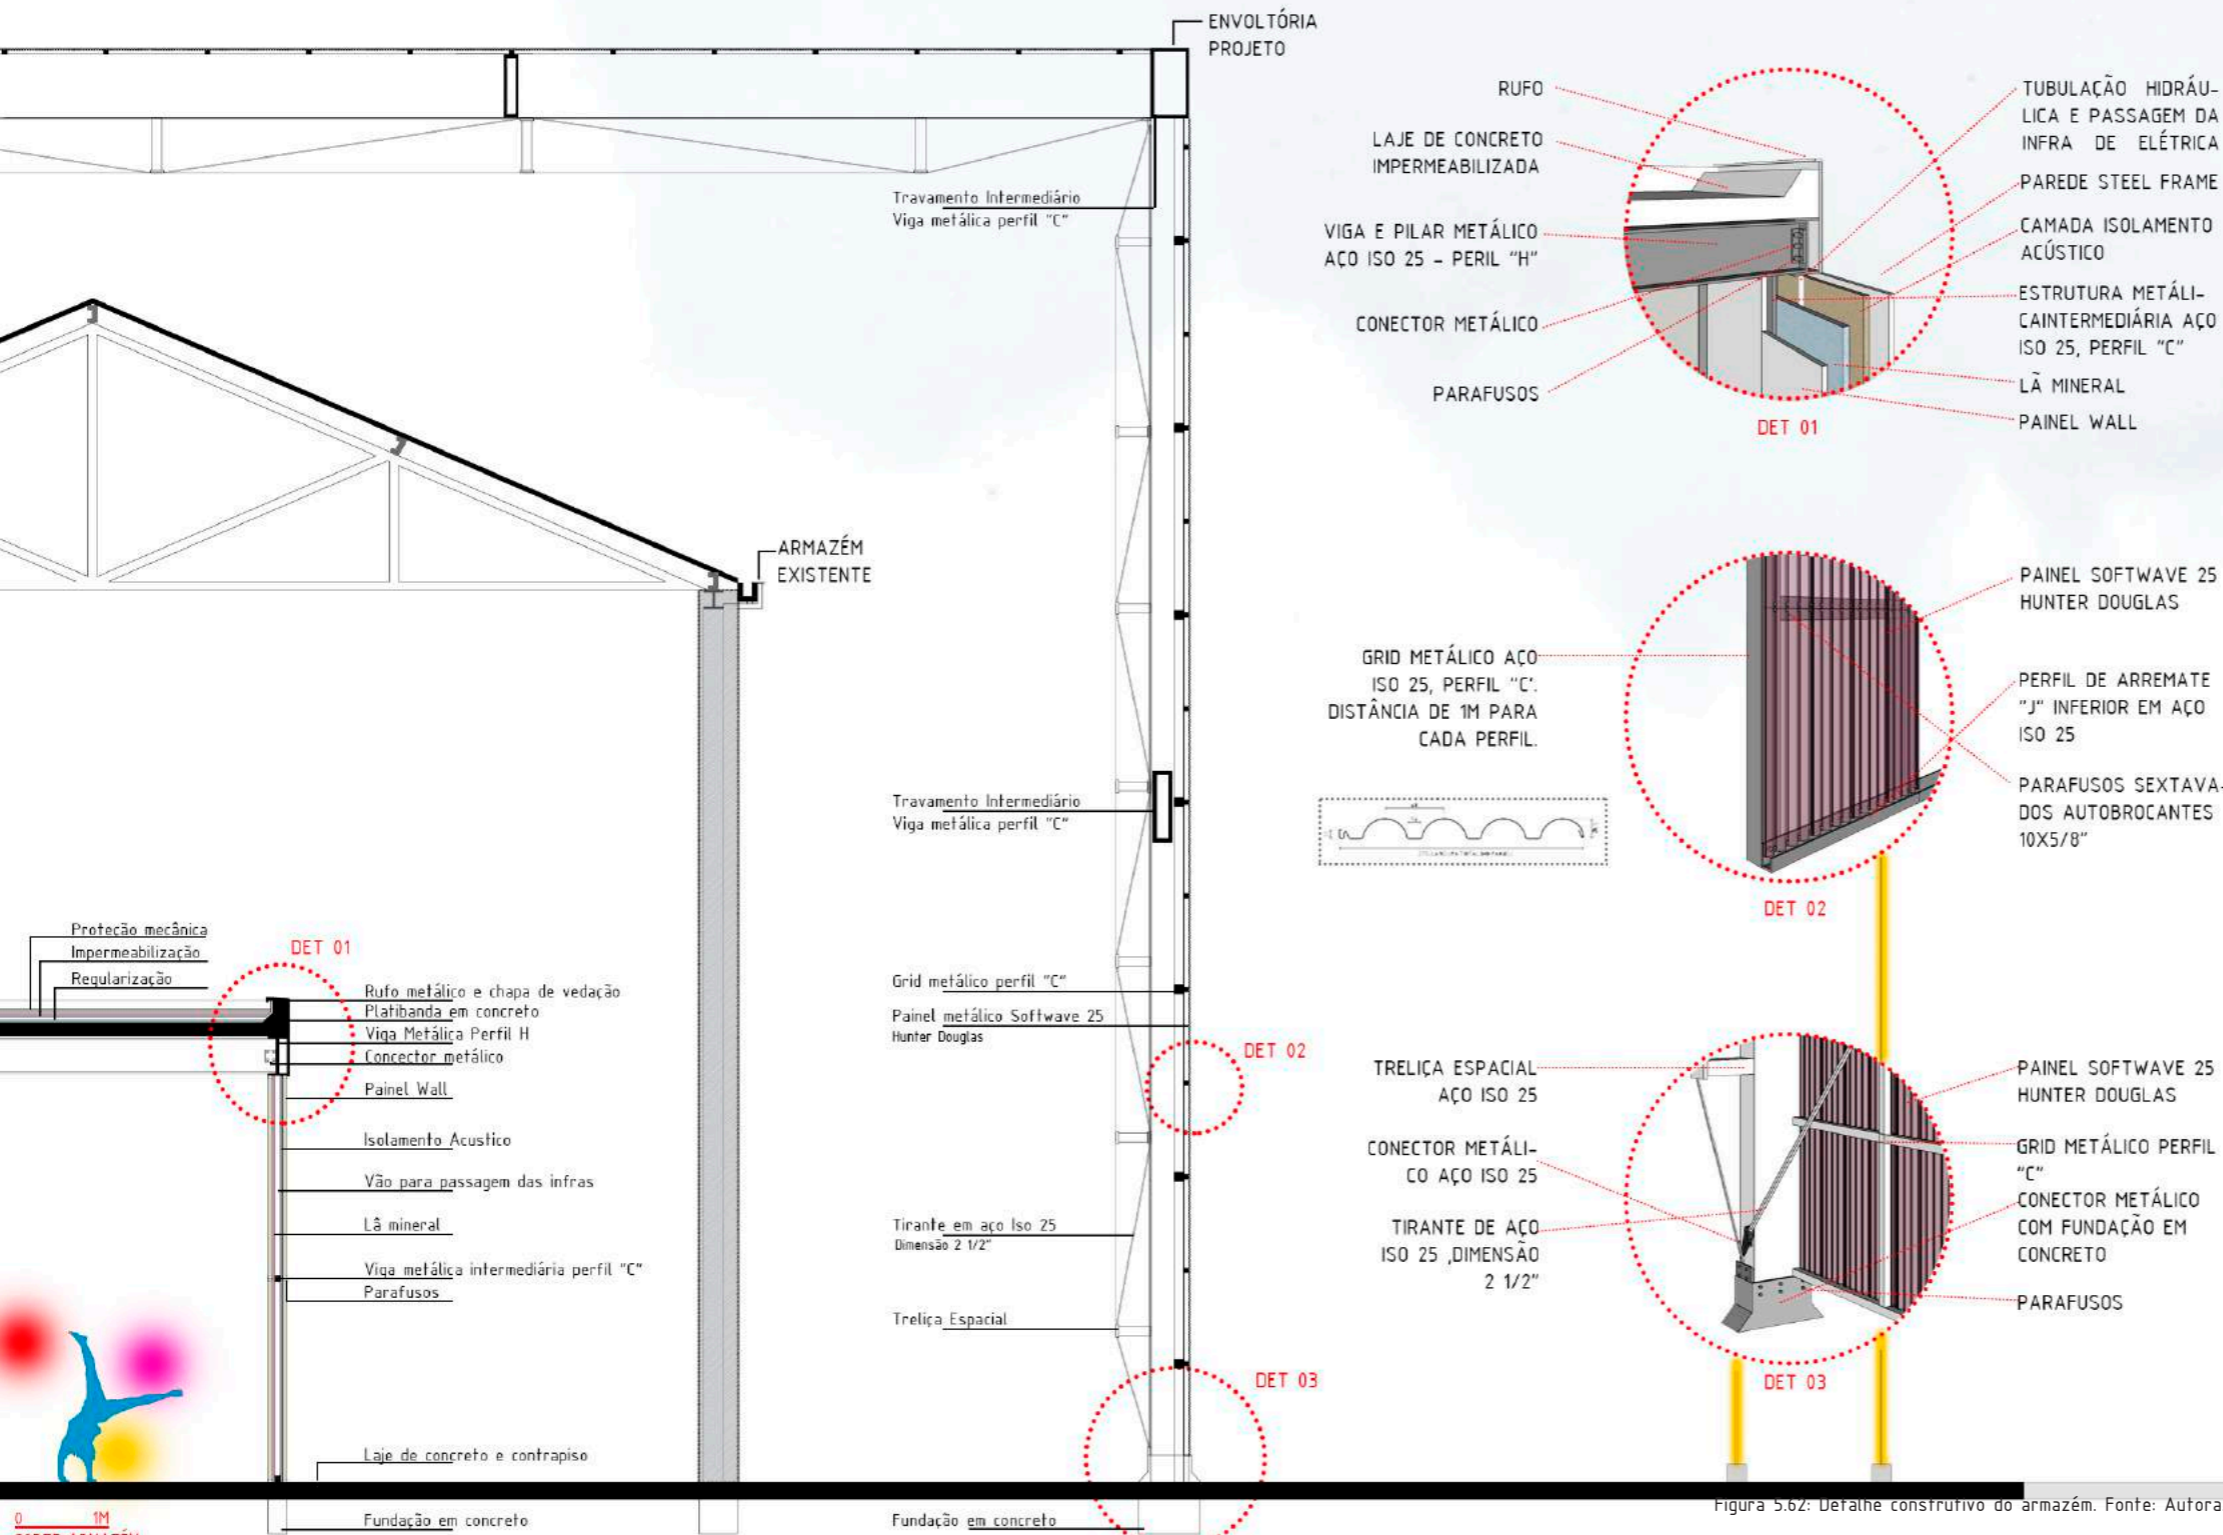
Detalhe construtivo do armazém. Fonte: Autora.
